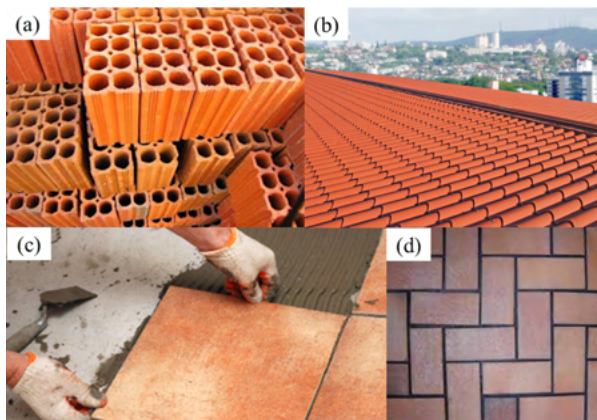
Aplicações da argila na construção civil: (a) tijolos, (b) telhas; (c) pisos e (d) ladrilhos.
